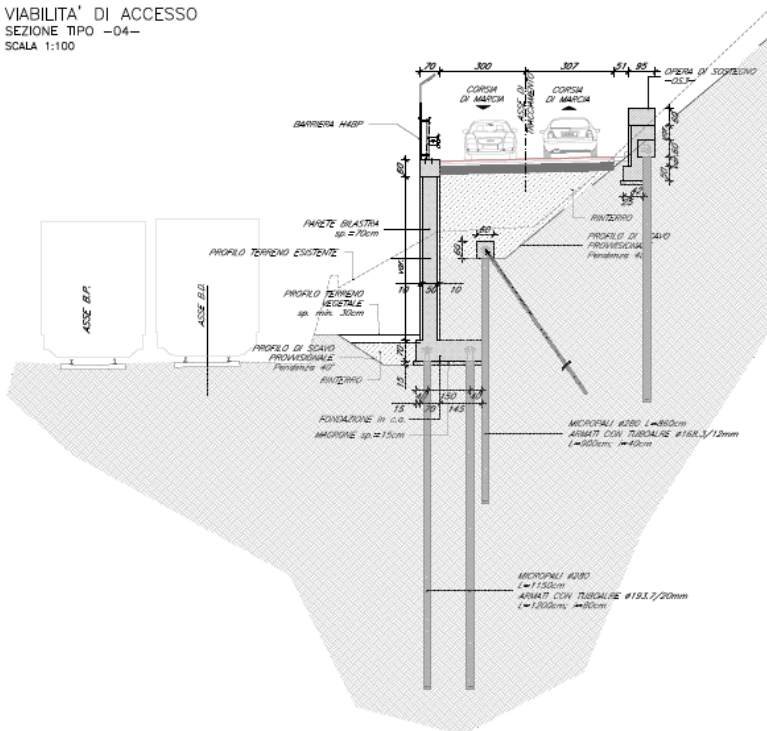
Viabilità di accesso – Sezione tipologica 4
